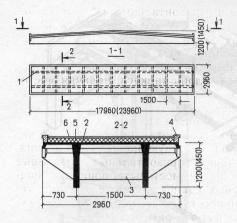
Комплексный блок-настил покрытия 2Т
